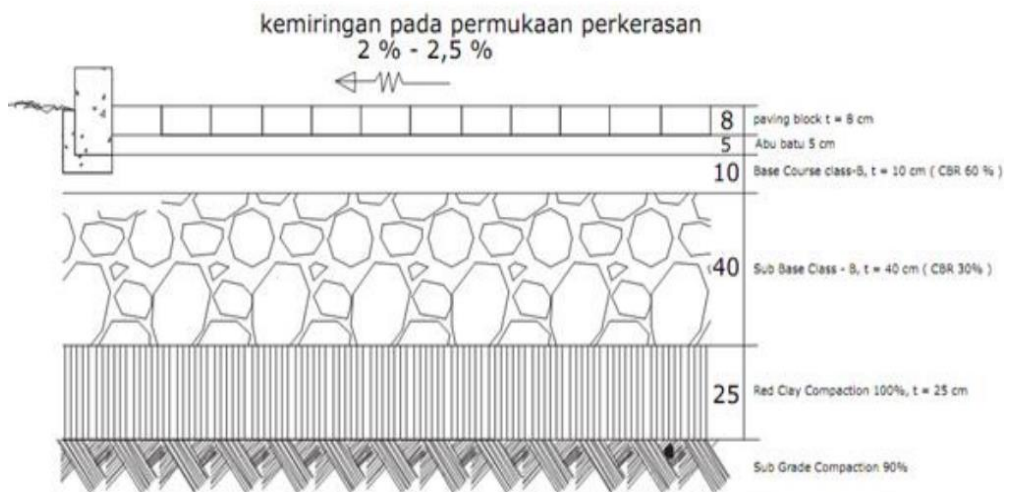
74 Denah Perkerasan Keliling Bangunan pada tipe Barak
